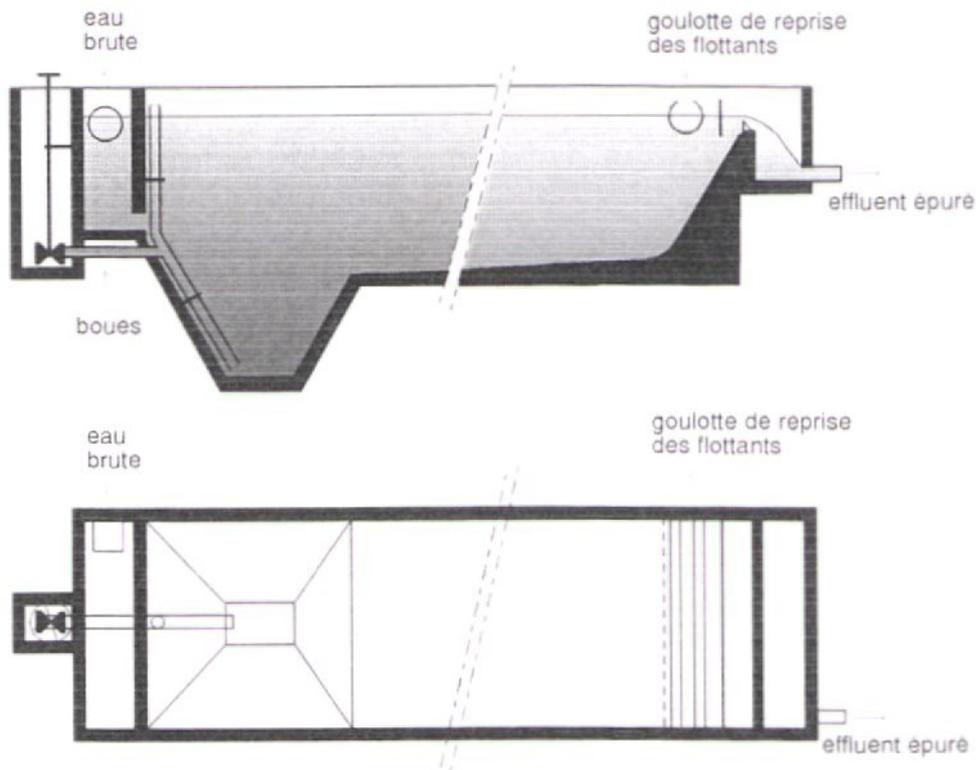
Schéma type d'un décanteur longitudinal (plan et coupe)
